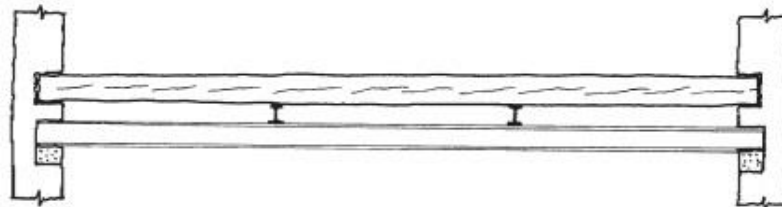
Viga parteluz de refuerzo. Arriaga Martitegui, Francisco. *Intervención en estructuras de madera*.
